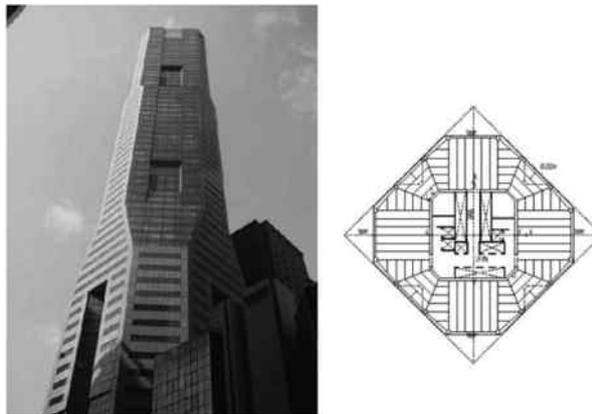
Общий вид отеля Плаза и план капитальных стен на уровне 16-го этажа.
